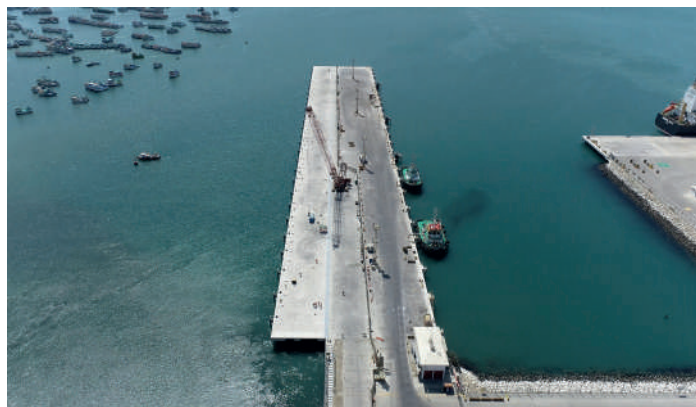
Vista aérea durante construção. Aerial view during construction.
